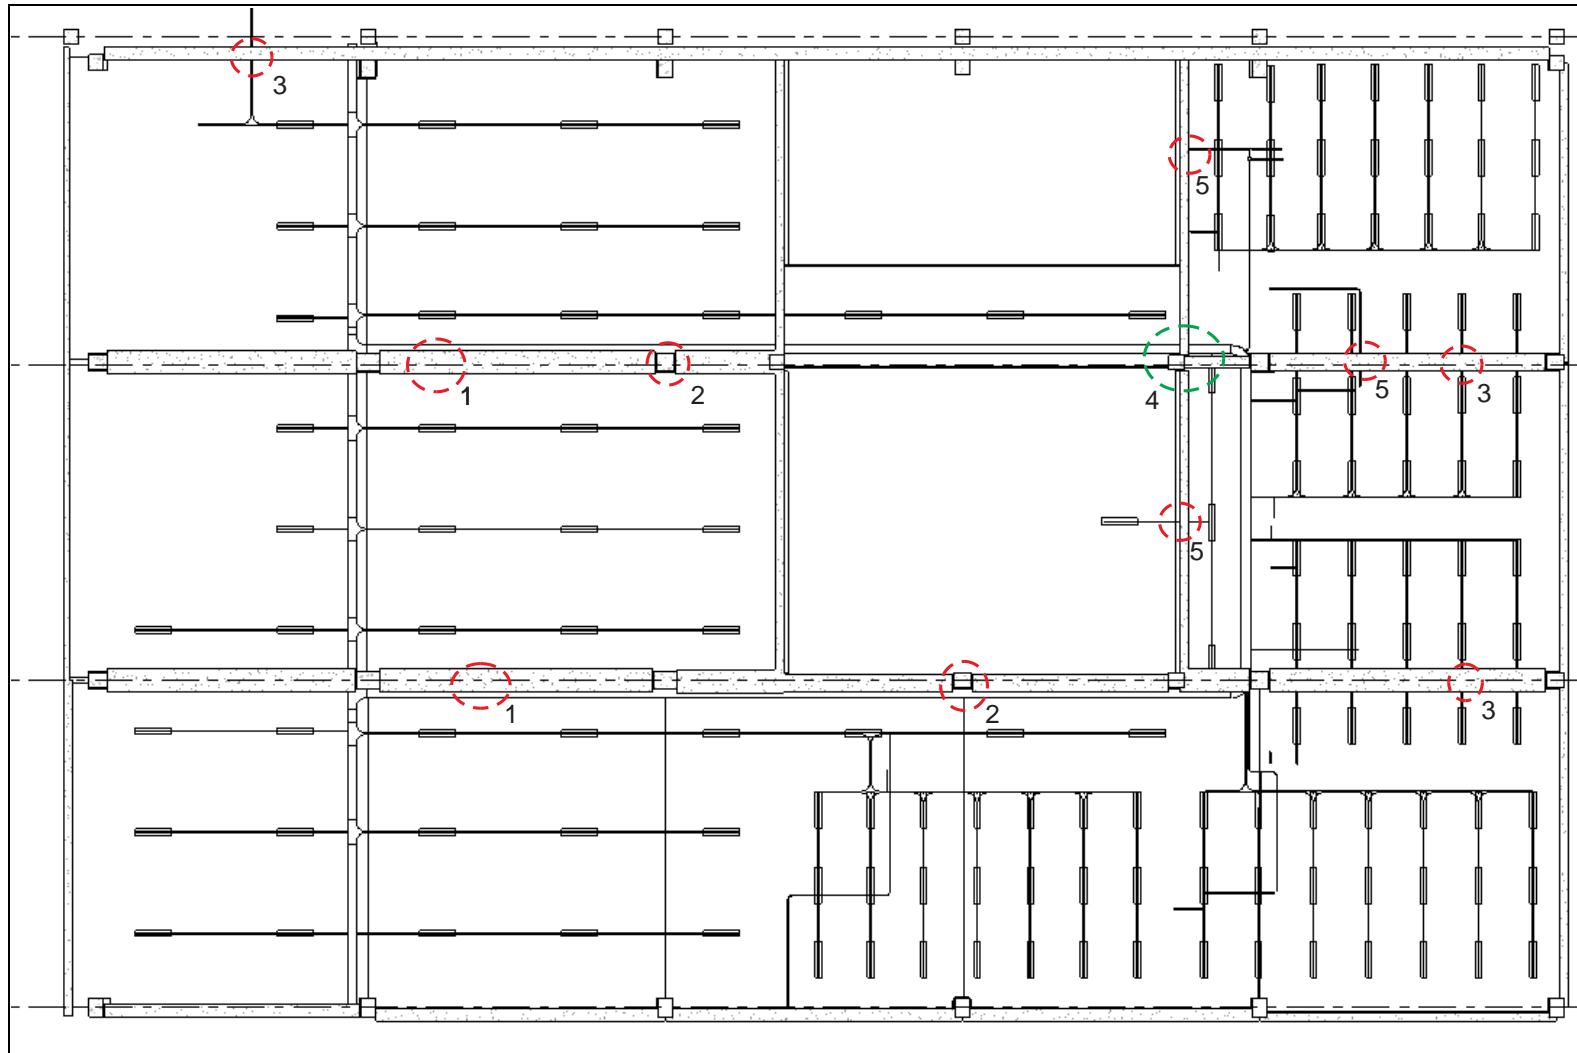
Planta baixa indicativa dos erros encontrados na compatibilização Estrutura X Instalações
